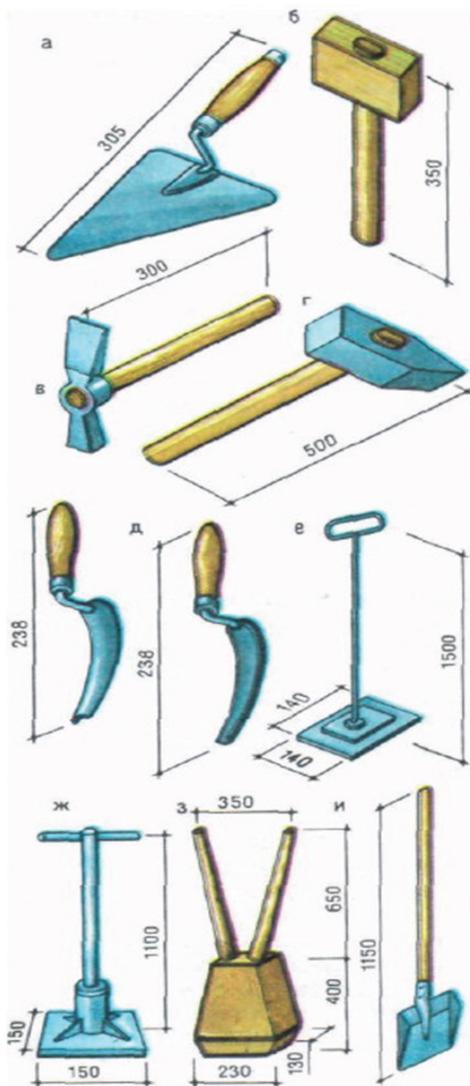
Рабочий инструмент для каменных работ: а – кельма (мастерок); б – киянка; в – молоток-кирочка; г – кувалда; д – расшивки; е – швабровка; ж – металлическая трамбовка; з – деревянная трамбовка; и – ковши-лопата.
